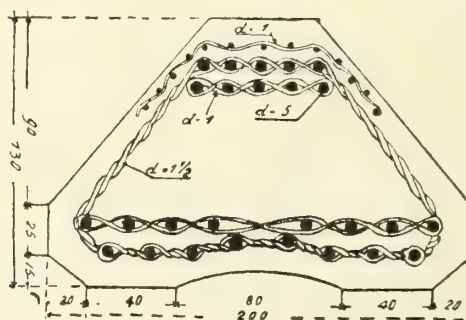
Neue Eisenbeton-Schwelle von Voitel
